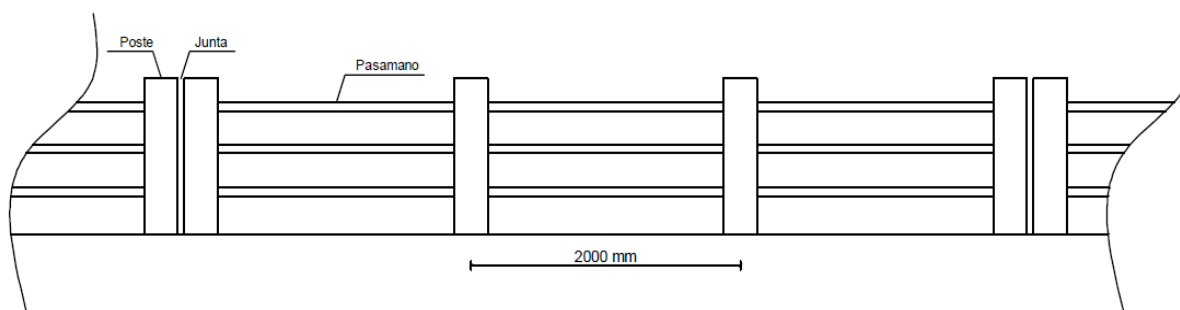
Juntas de dilatación armado longitudinal de la protección lateral. Elaborado por: Autor
